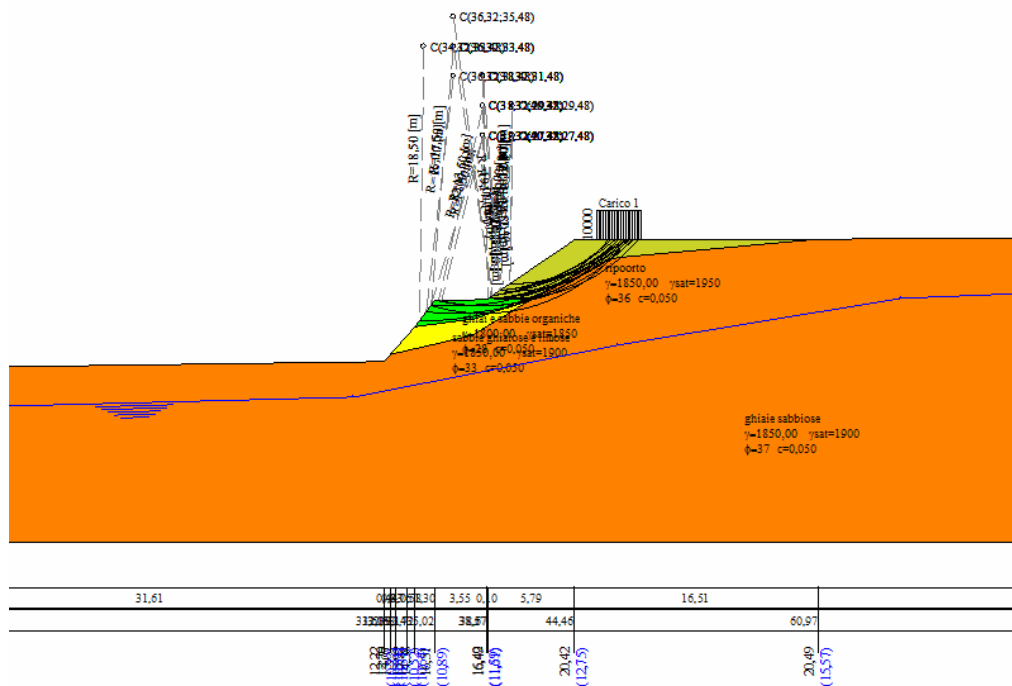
Stabilitätsnachweis mit Rutschflächen mit $F > 1,10$.
